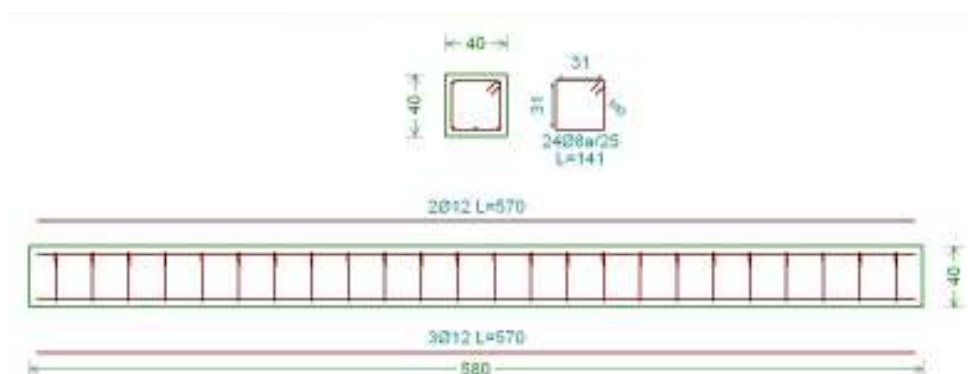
Secção e armadura da viga de fundação calculada (Fonte: Frutuoso Sousa, 2013).
